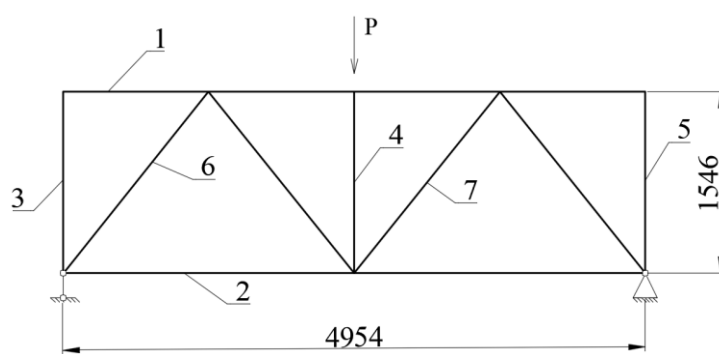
Конструктивна схема зварної ферми, схема її базування і навантажування
